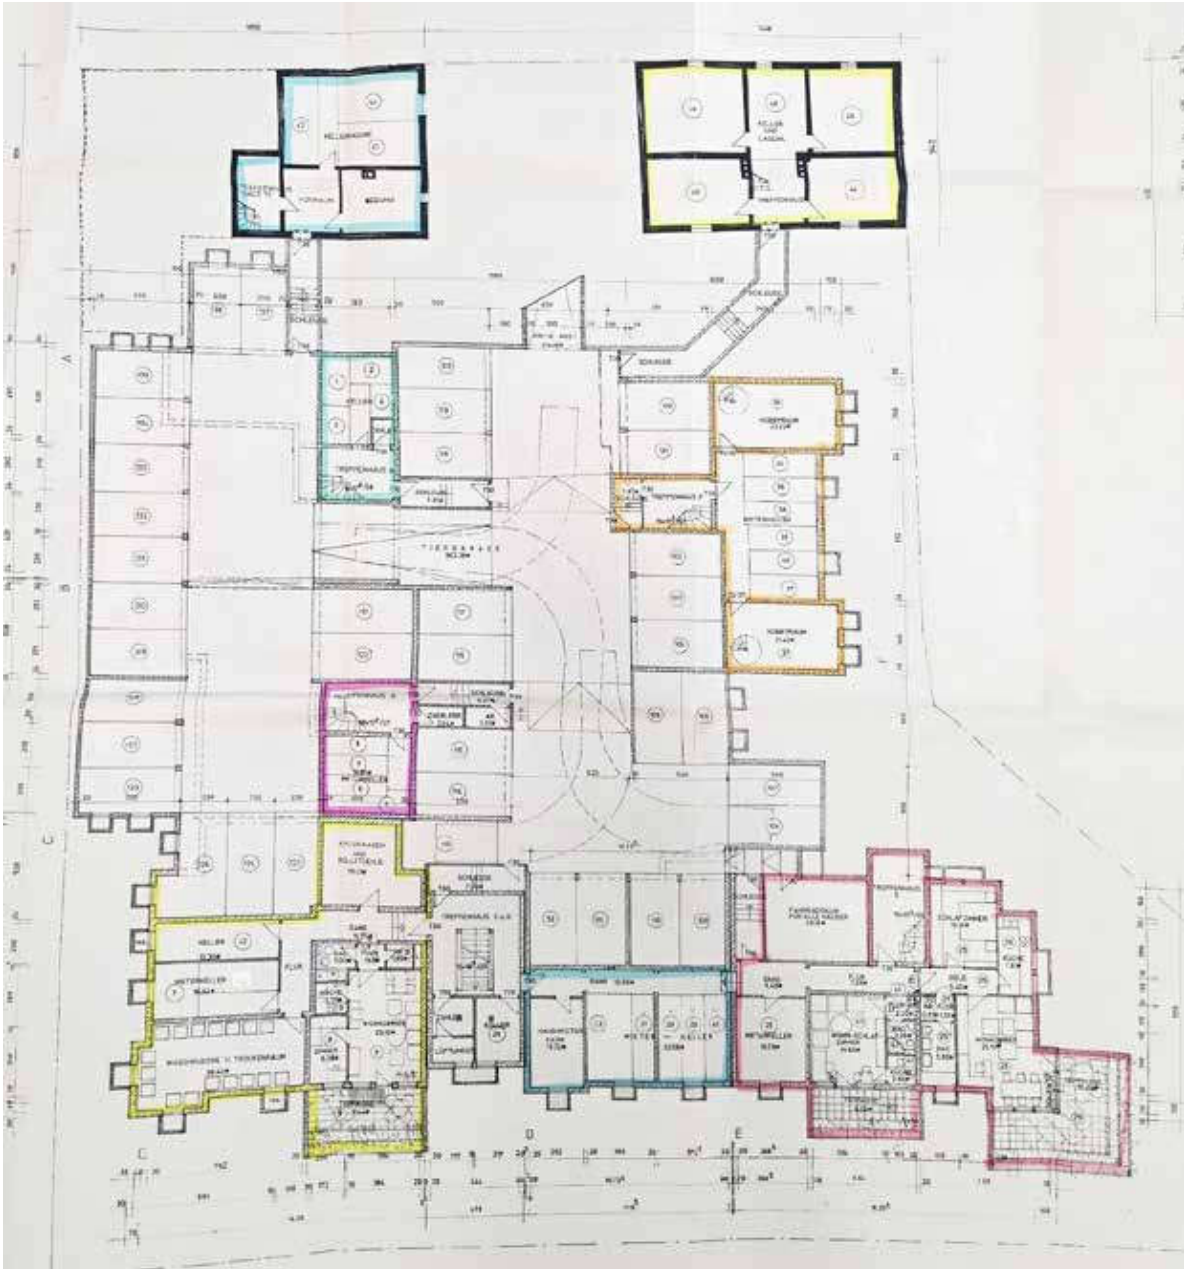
Grundriss des Kellergeschosses der Gesamtanlage, mit Tiefgarage
